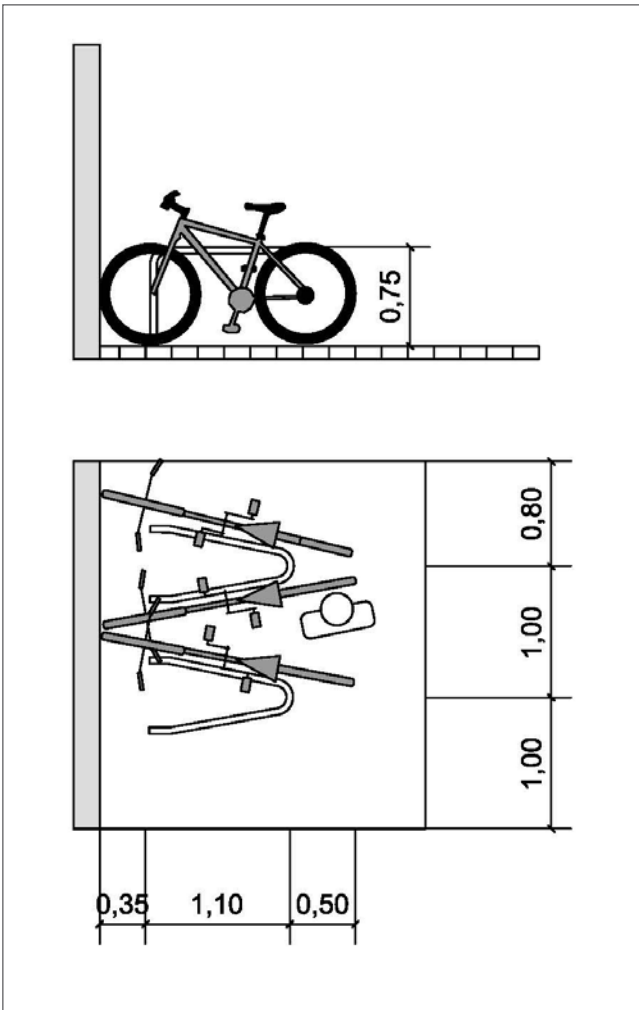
V-förmiger Bügel mit 1,0 m Achsabstand
